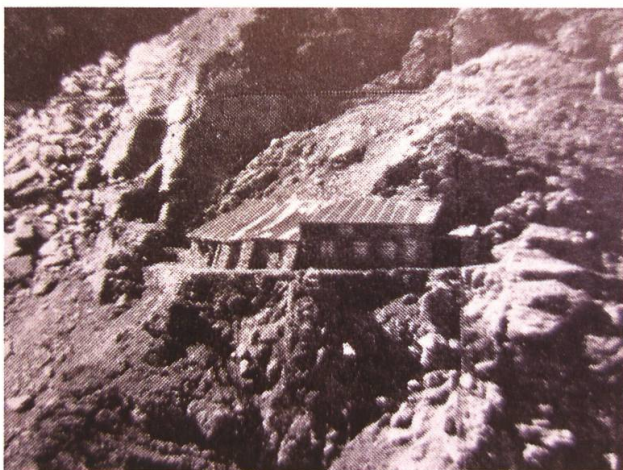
Rechts am Gebäude sichtbar der Anbau mit dem Kompressor. Der linke Teil der Baracke war nur noch einstockig aufgebaut worden (Choffat 1946)
